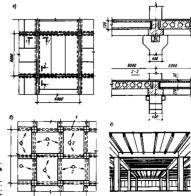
Перекрестная укладка настилов в перекрытин:
